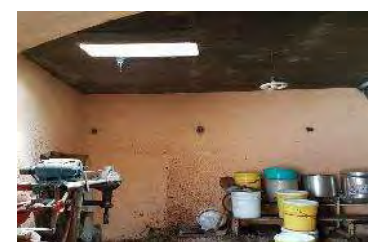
Losa de concreto en el espacio para elaboración de dulces
